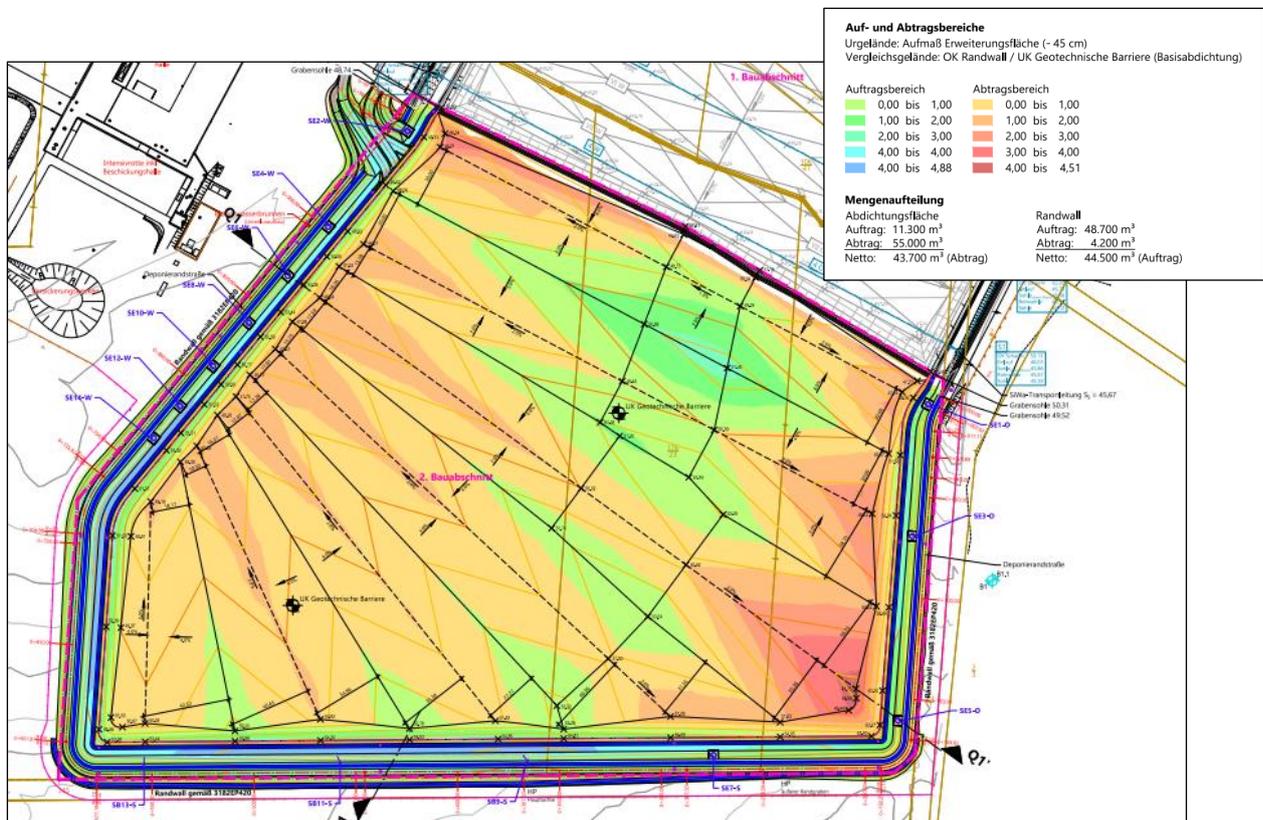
Lageplan UK Basisabdichtung 2. Bauabschnitt - UK Geotechnische Barriere inkl. Auf- und Abtragbereiche /12/
